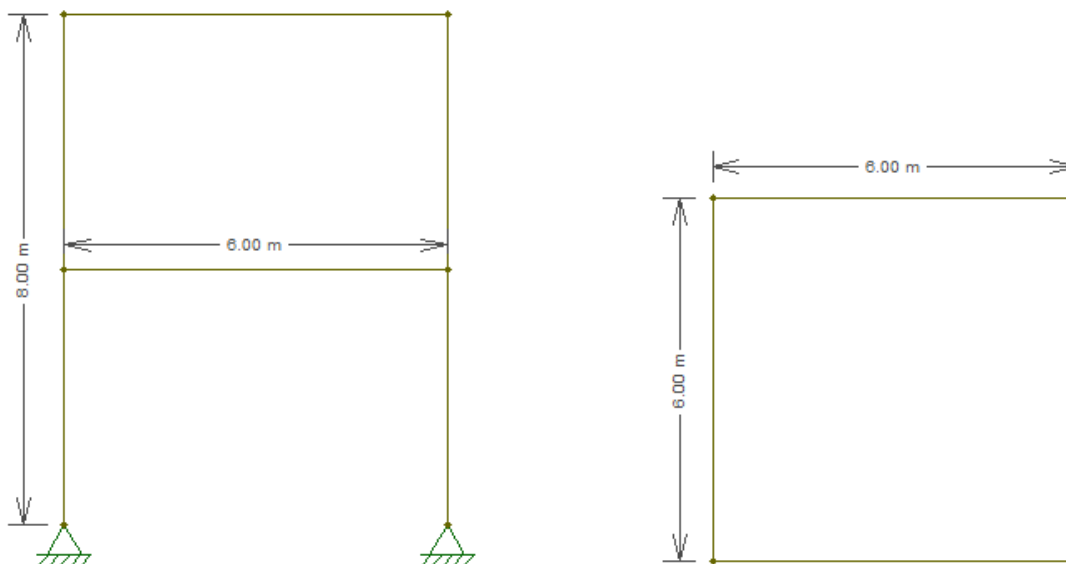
Pórtico-tipo um e planta da estrutura selecionada.
